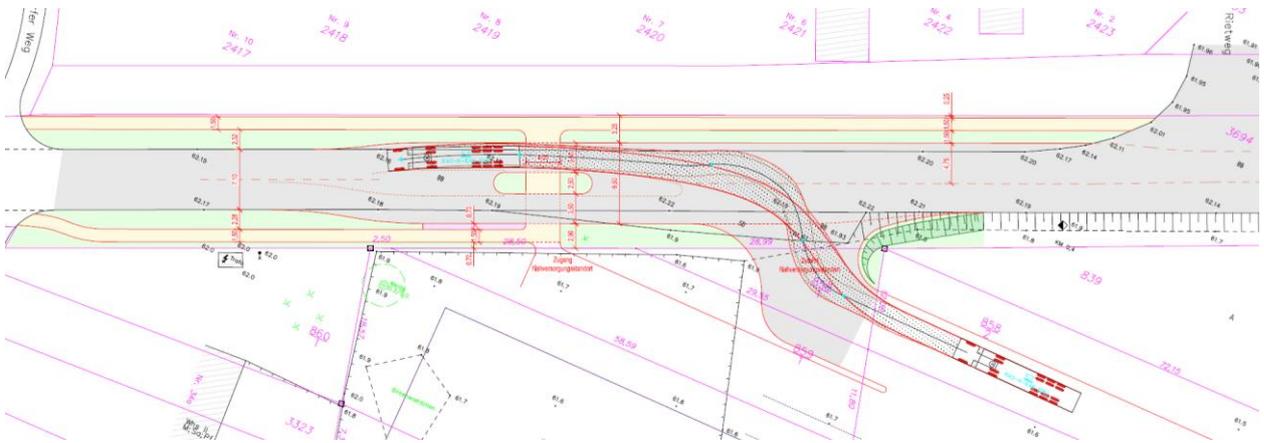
Lageplan- Schleppkurven Ausfahrt links– Erschließung und Anbindung Nahversorgungsstandort, Quelle: Wunderlich GbR, 10.08.2022
